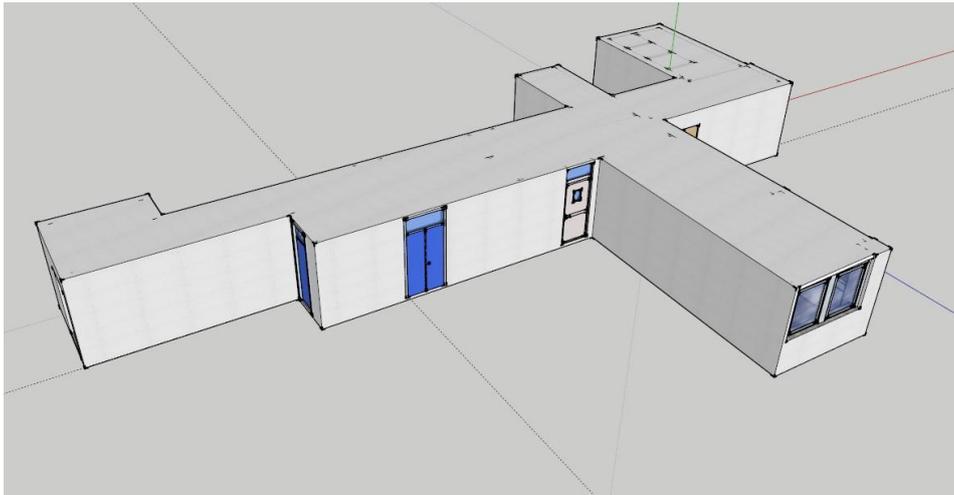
PIANTA DELL'AMBIENTE RICOSTRUITO
